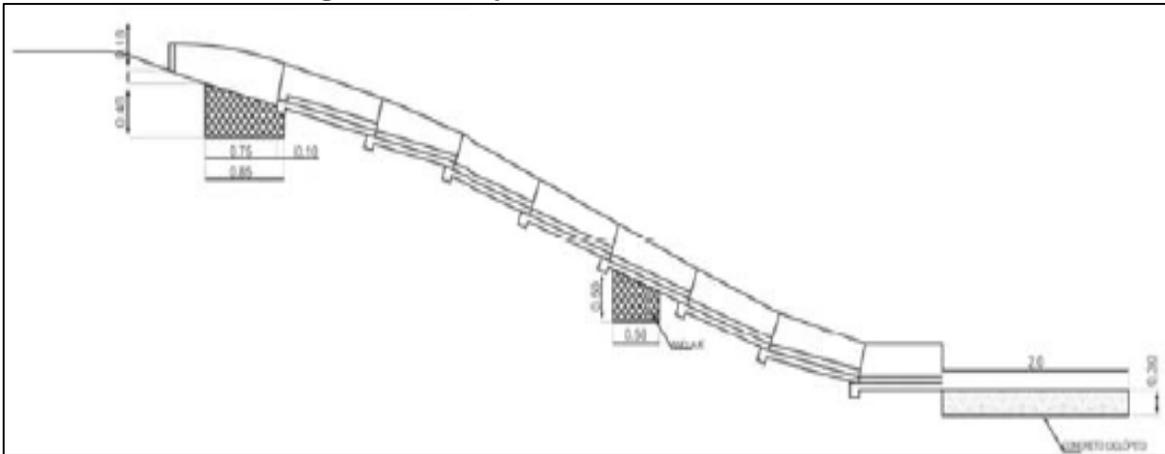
Cuneta en borde de terraplén – Sección tipo en calzadas separadas
